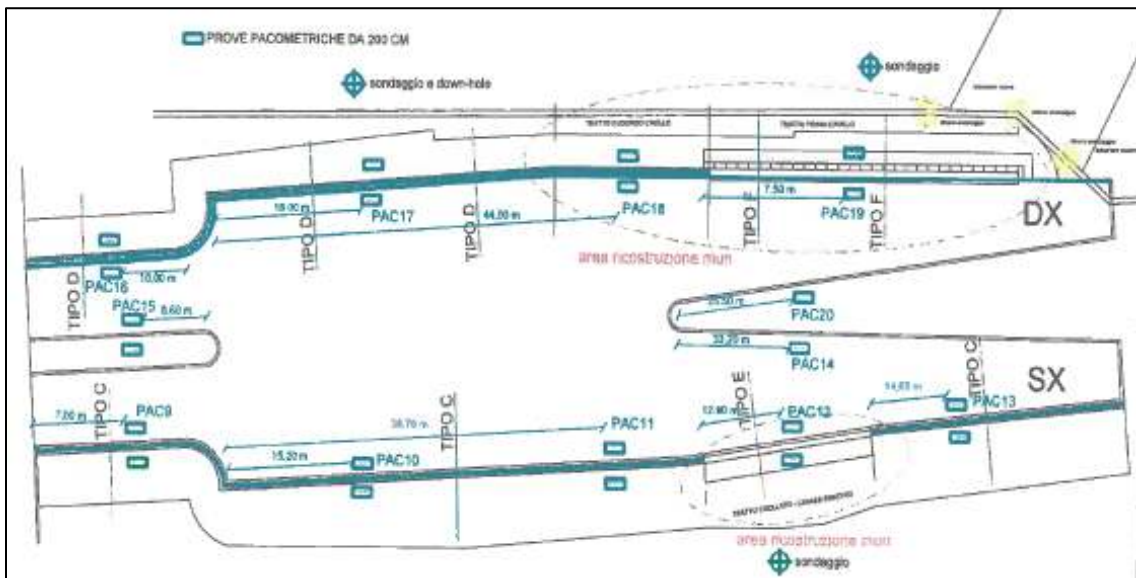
Planimetria generale con ubicazione indagini eseguite il 23/05/2018
